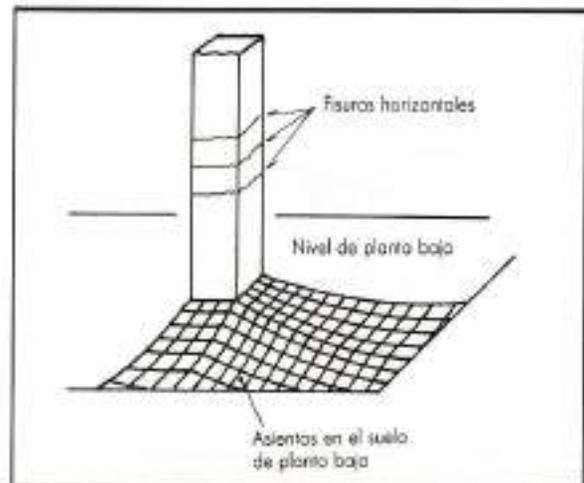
Fisuras en pilares interiores y asentamientos de la solera de planta baja.
